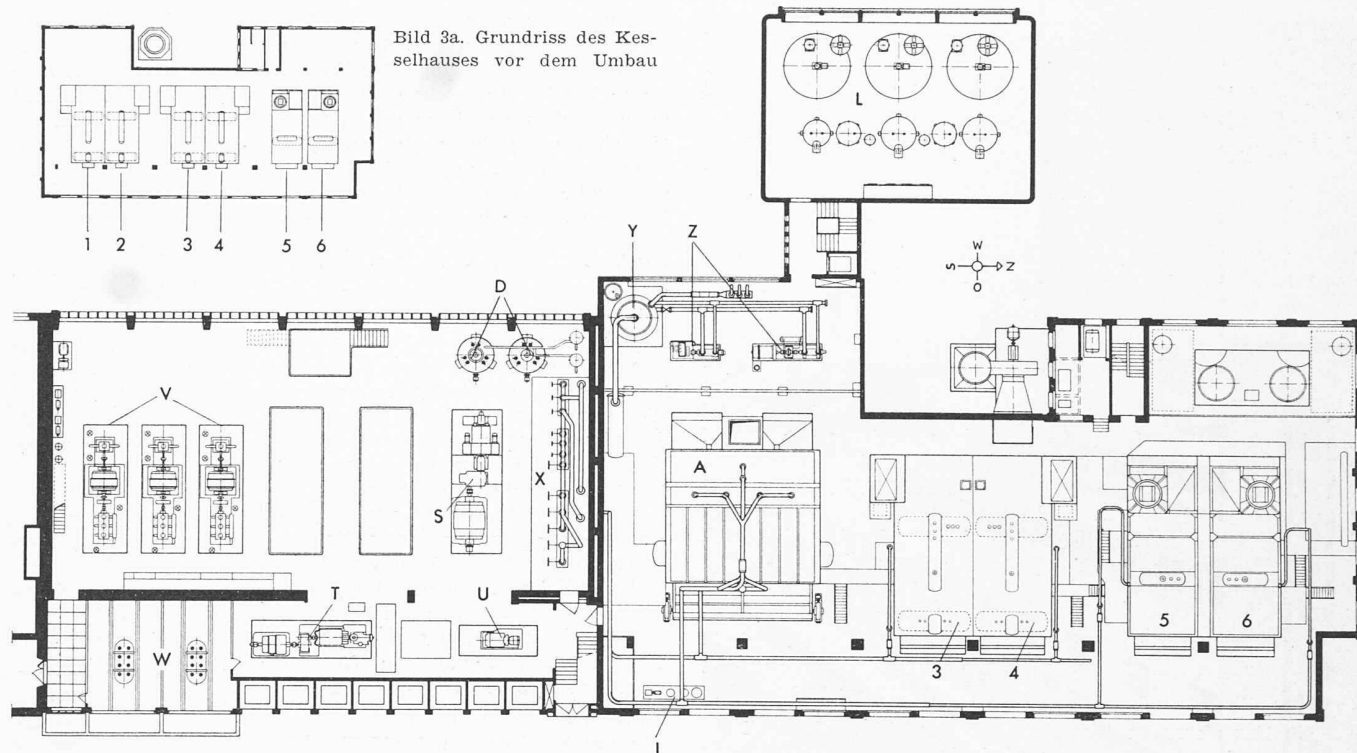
Grundriss des Kesselhauses vor dem Umbau
